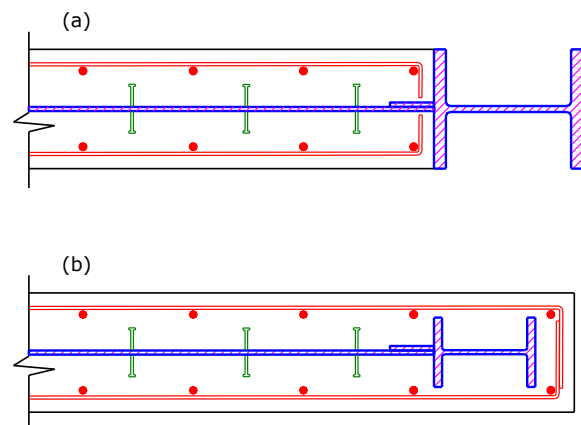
Ejemplos de muros de corte con placas de acero rigidizados con hormigón (a) con miembro de borde de acero, y (b) con miembros compuestos embebidos en los bordes.
